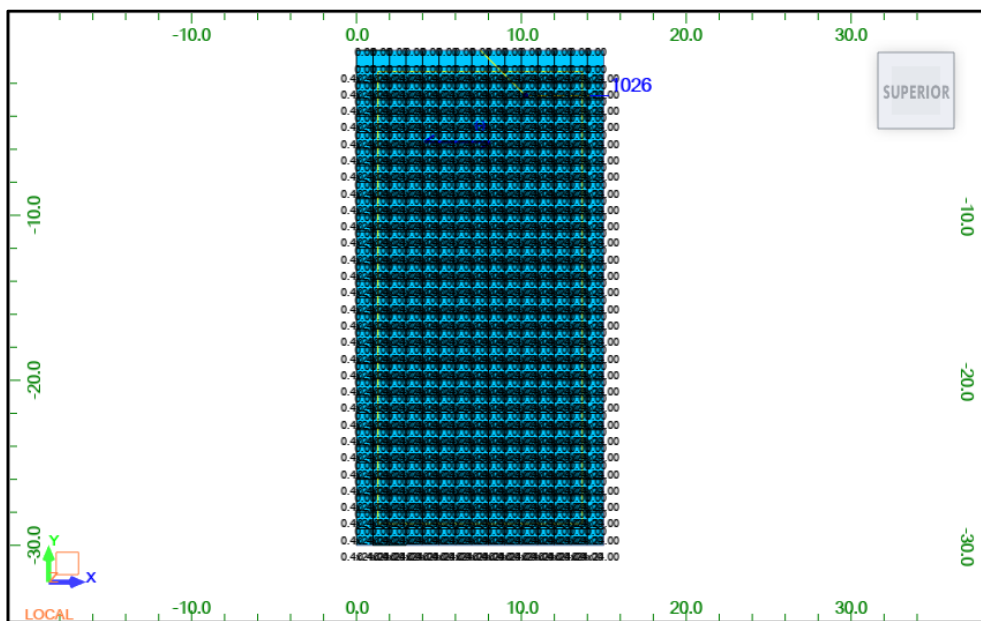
Dimensionamiento preliminar de la losa de cimentación.
